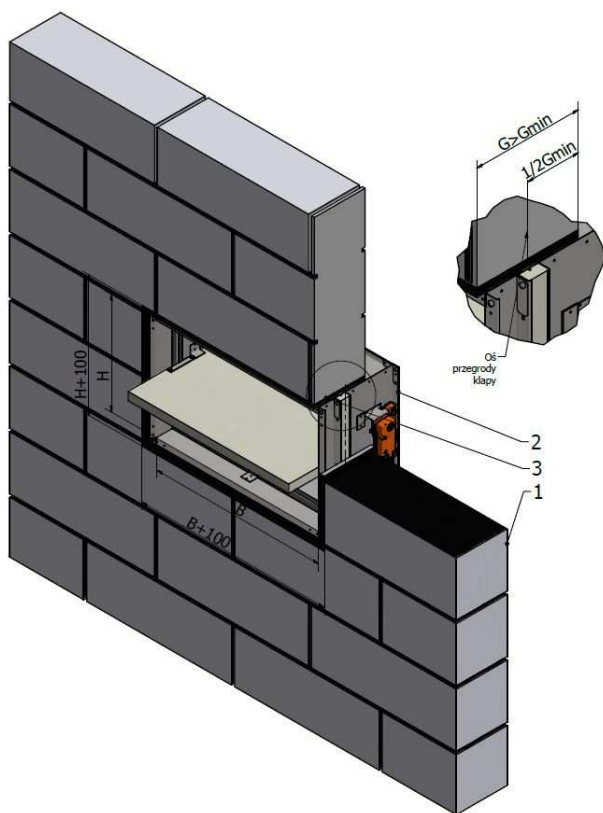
Przykład montażu kłapy VD370-TC w ścianach betonowych lub murowanych
